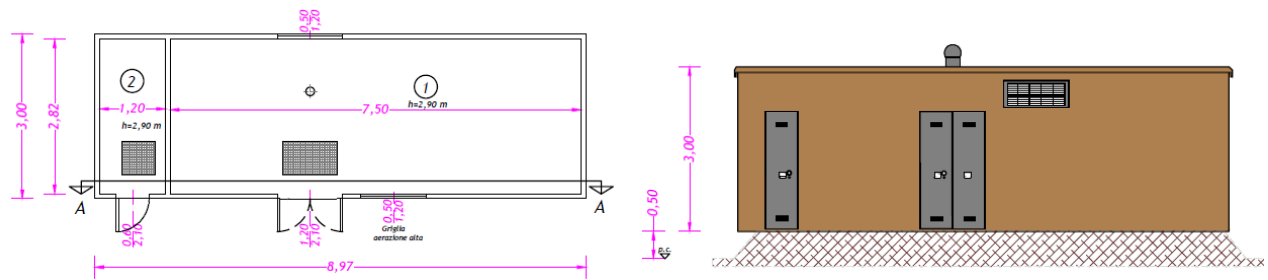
Pianta e profilo delle cabine MT Utente 1 e 2
